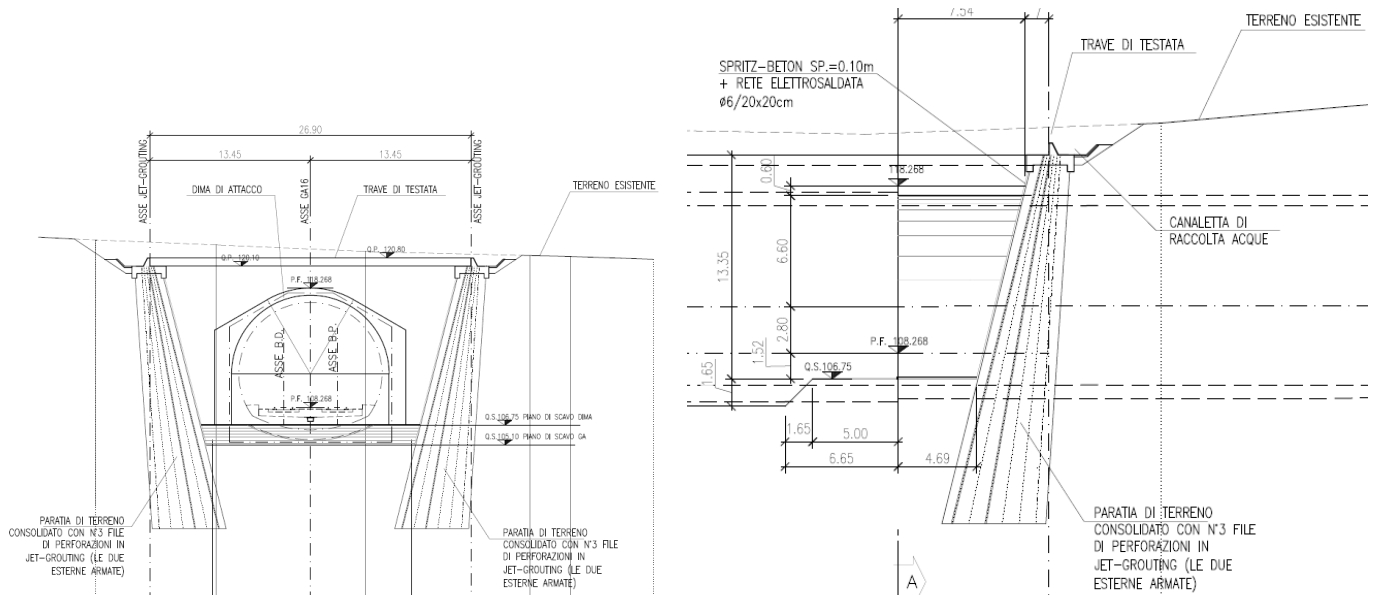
Sezione trasversale e longitudinale della paratia in jet grouting all'imbocco lato Milano GI08.
